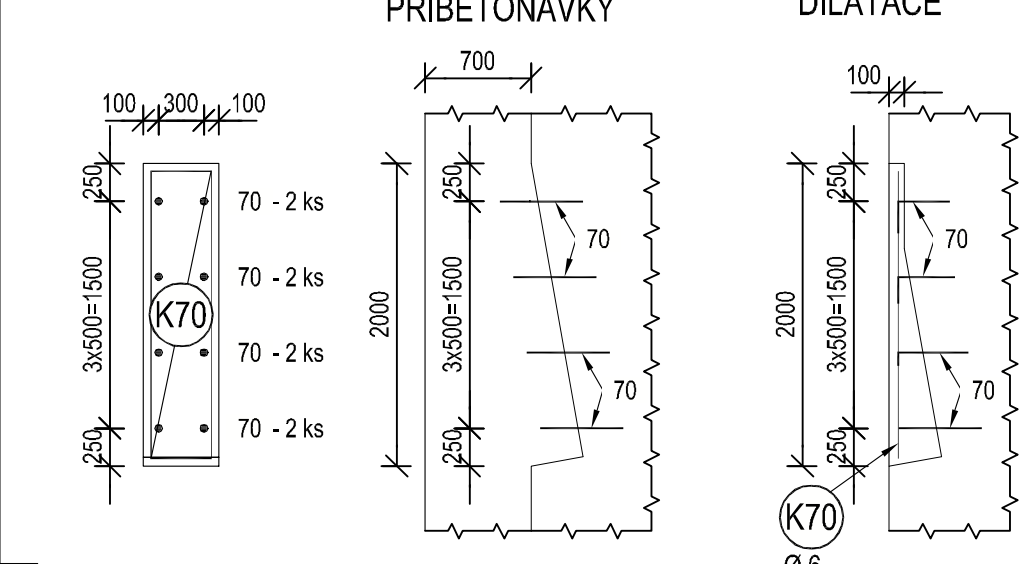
DETAIL V MÍSTĚ VÝKLENKŮ M 1:50
